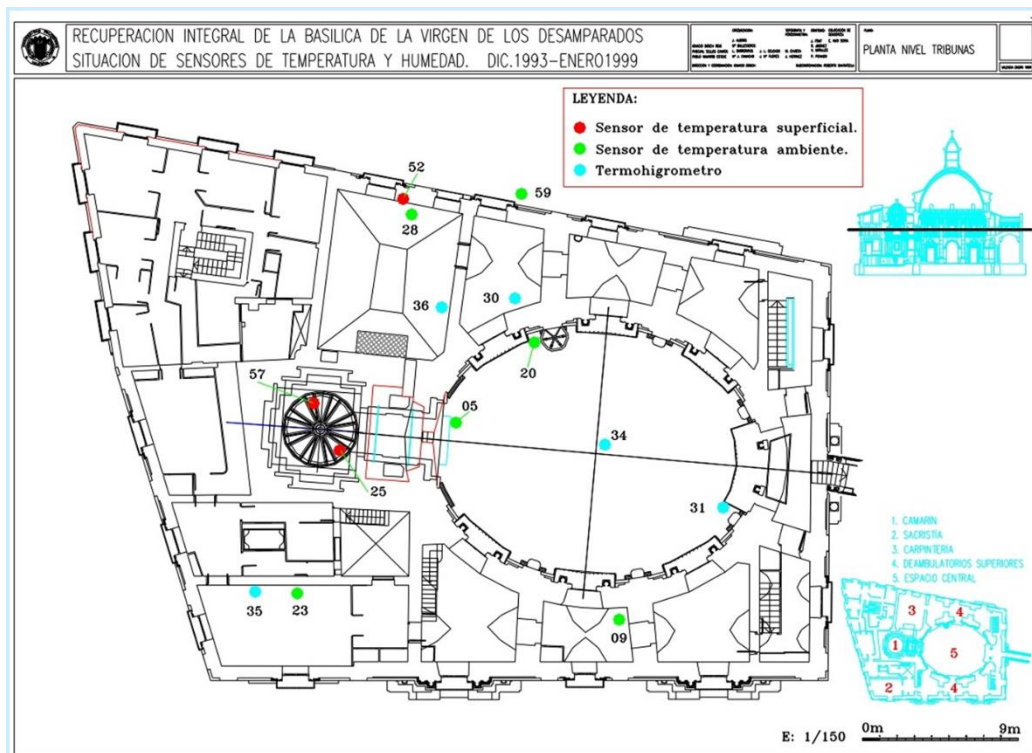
Plano situación de sensores. Planta nivel tribunas. Basílica de la Virgen.
